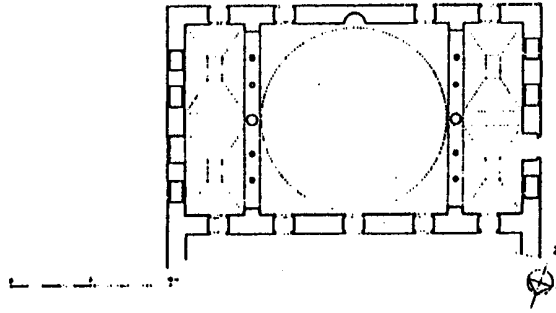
مسقط أفقي لجامع عبد القادر الجيلاني ببغداد (عن : Ulucam)
